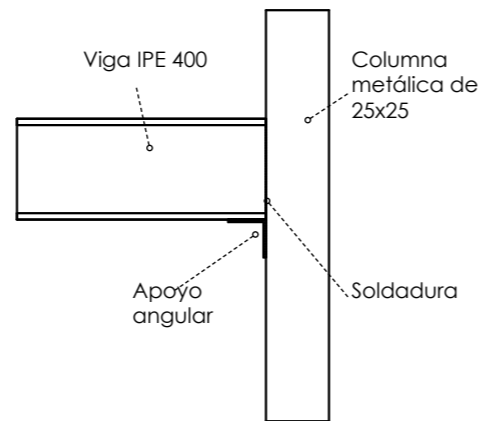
Unión columna-vigas Elaboración propia (2026). V1-P1
